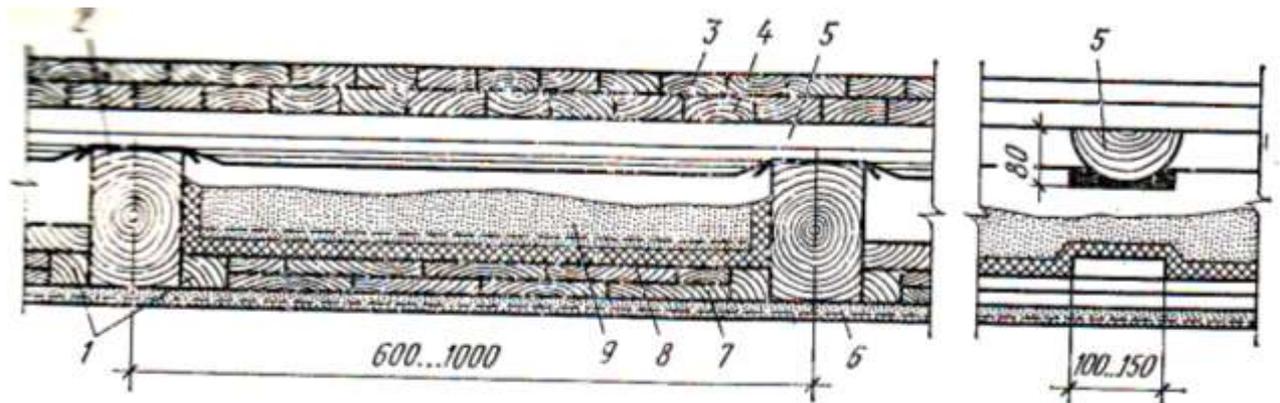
Конструкция деревянного междуэтажного перекрытия
